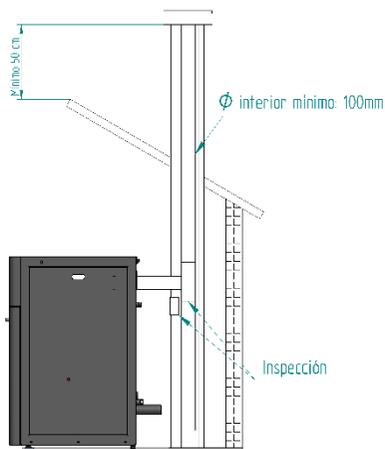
Vista lateral de la instalación con chimenea, con ejemplo del punto de inspección
